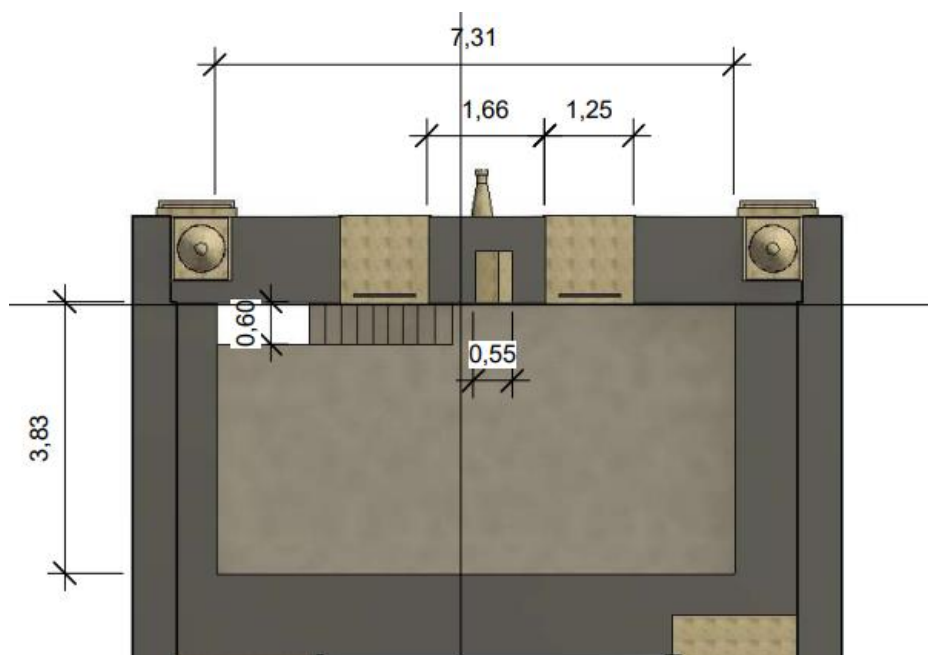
Planta do Segundo Piso sobre a Sacristia
